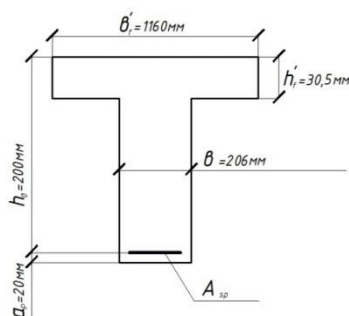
Поперечное сечение многопустотной плиты (для расчета по первой группе предельных состояний)
